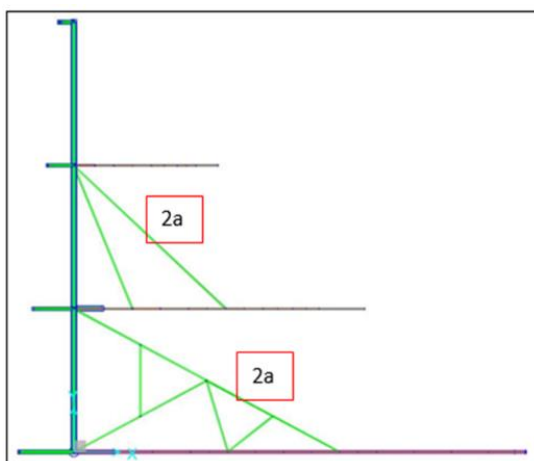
Extrusión – planta. Fuente: Solpesa SAC. (2023).
